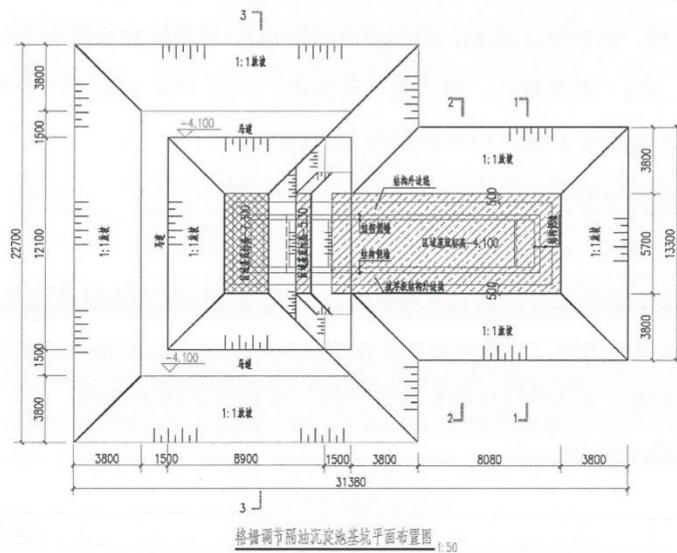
格栅调节隔油沉淀池基坑平面布置图
